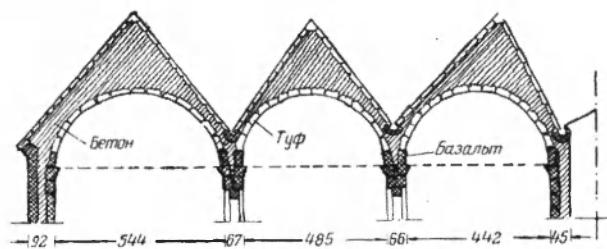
Схема поперечного разреза перекрытия нахагавита Санаина
